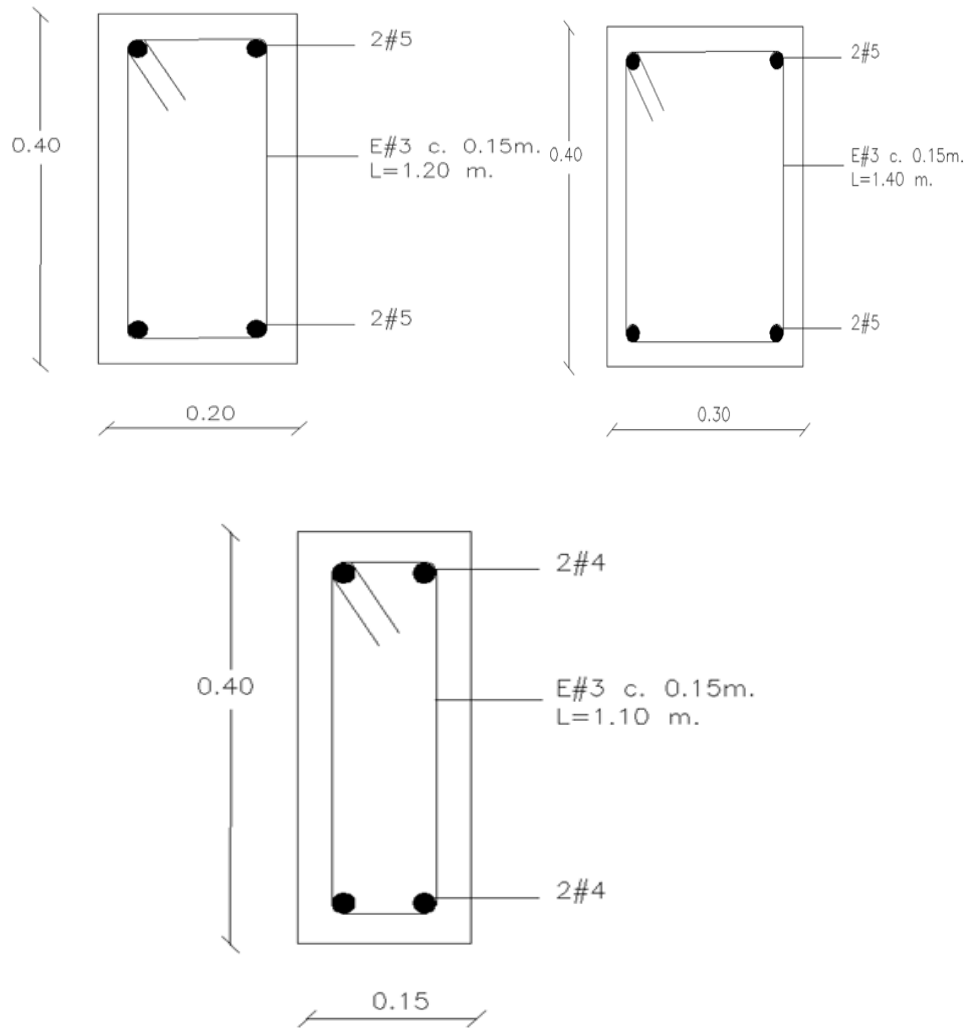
Sección y Detalles de Vigas. (Fuente: GRACOL. SAS).
